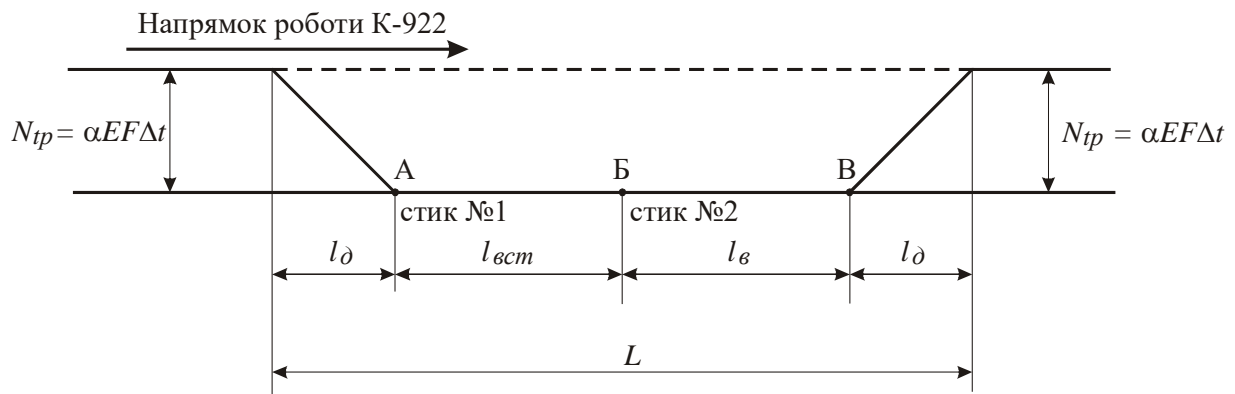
Схема ділянки робіт при зварюванні рейкових плітей
